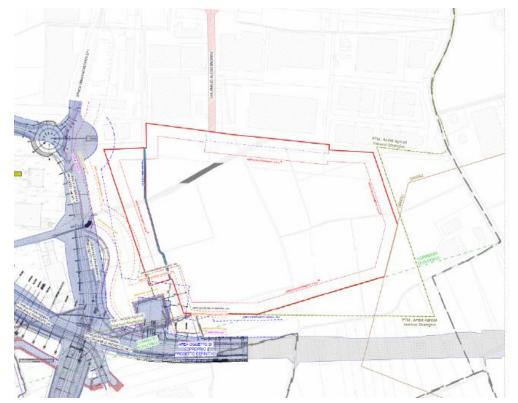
Planimetria estratta dalla Relazione Illustrativa della Proposta di PA
